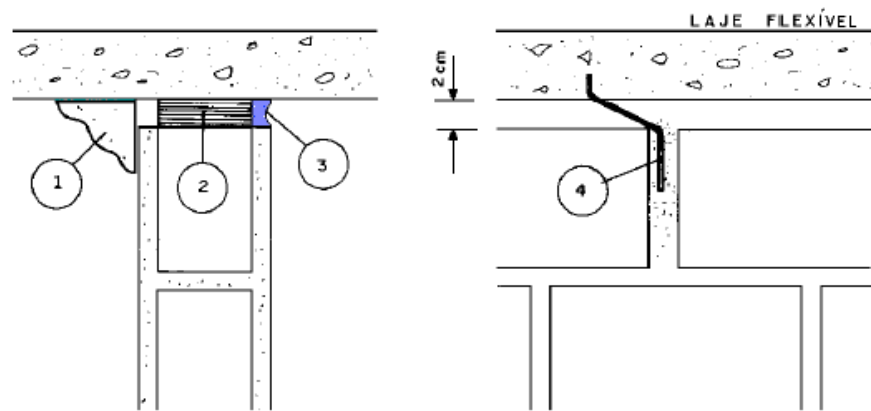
Detalhes de ligação das alvenarias com viga ou laje muito deformável: (1) moldura de gesso; (2) material deformável (3) selante flexível; (4) gancho de aço \varnothing 5 ou 6 mm (THOMAZ, 2000).
